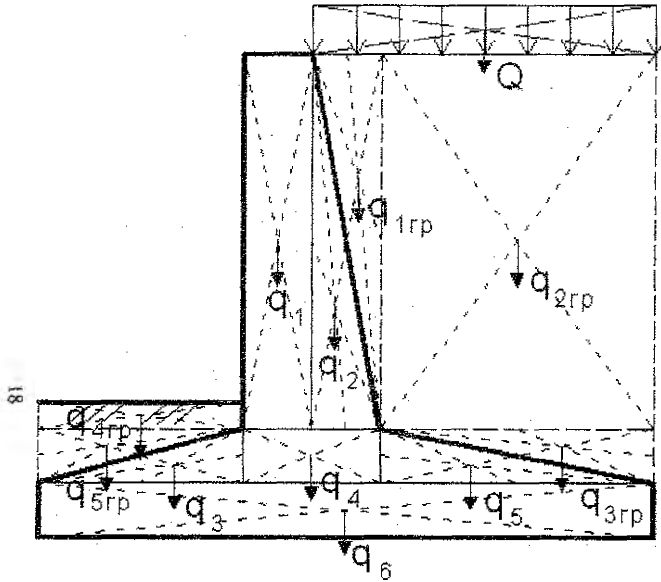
Схема вертикальных нагрузок, действующих на подпорную стенку в период строительства
